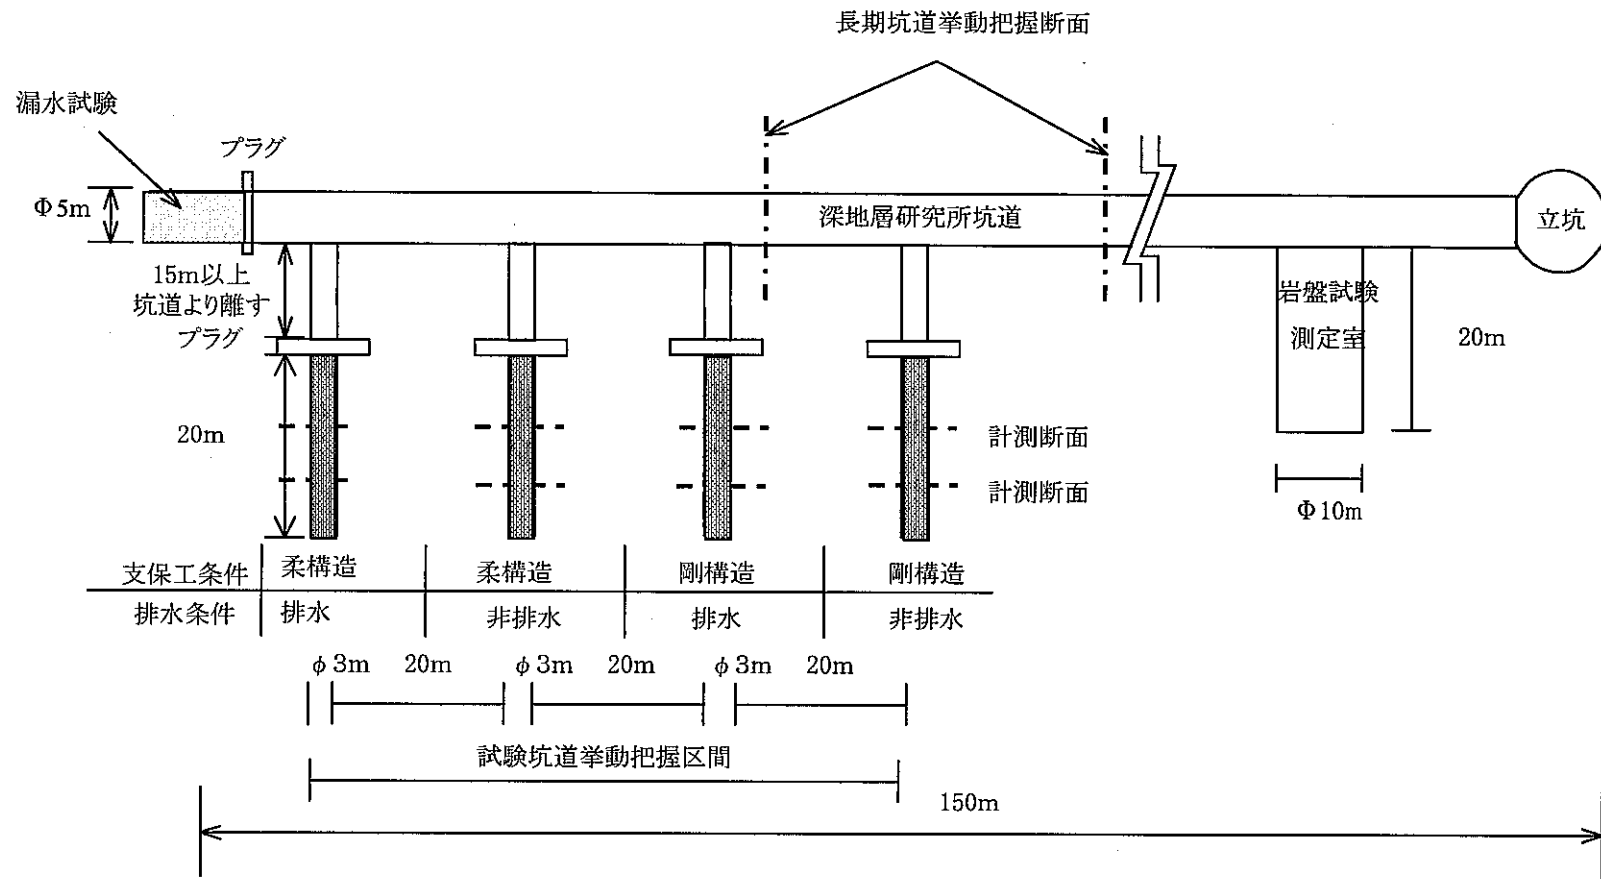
15 長期挙動測定試験レイアウト平面図 (1)
